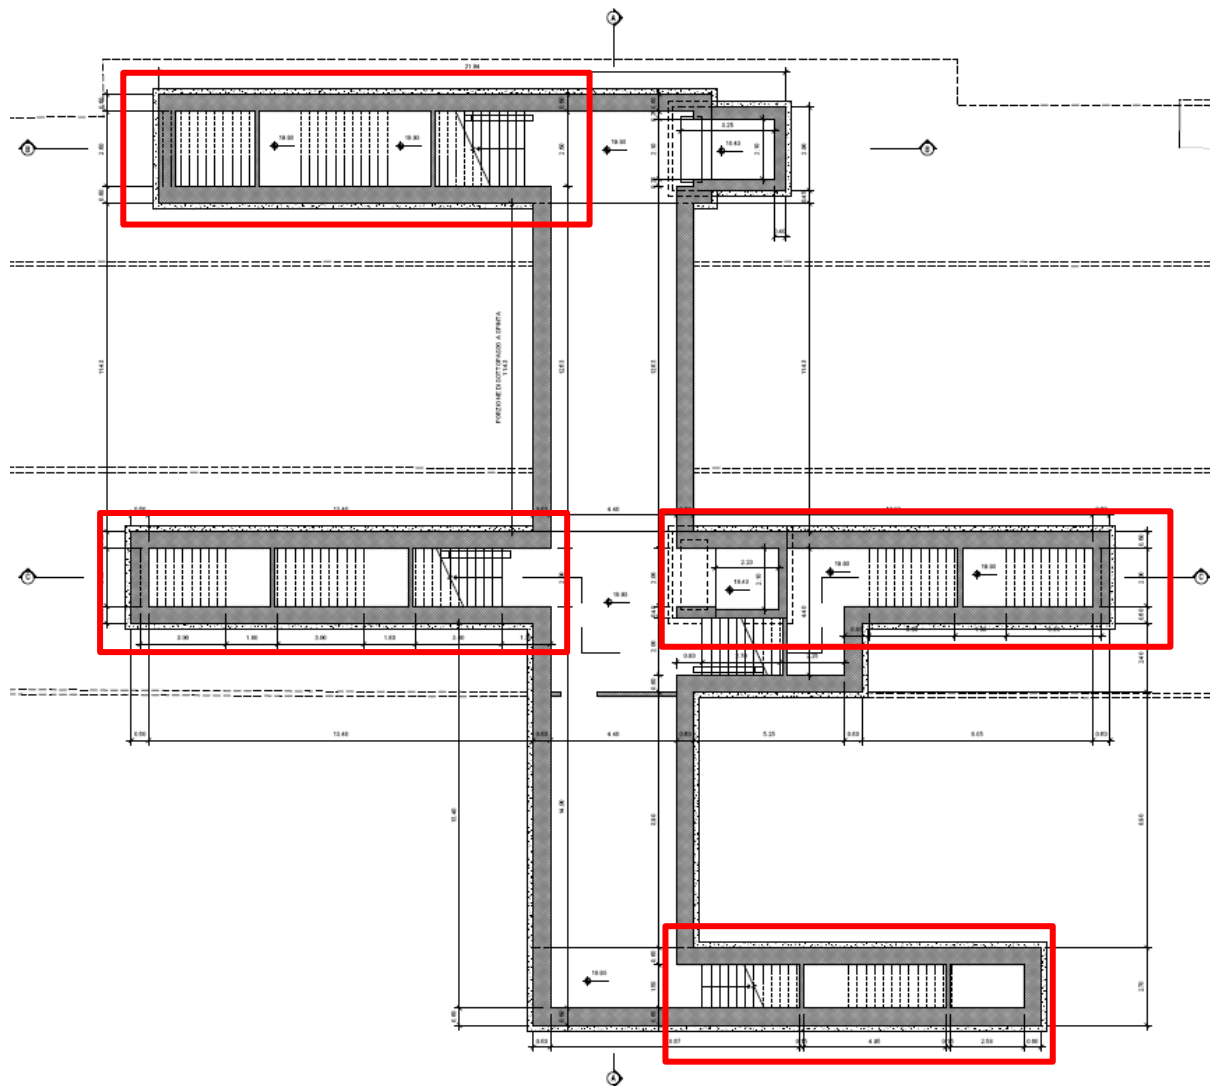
Planimetria dell’opera con individuazione del sottopasso
